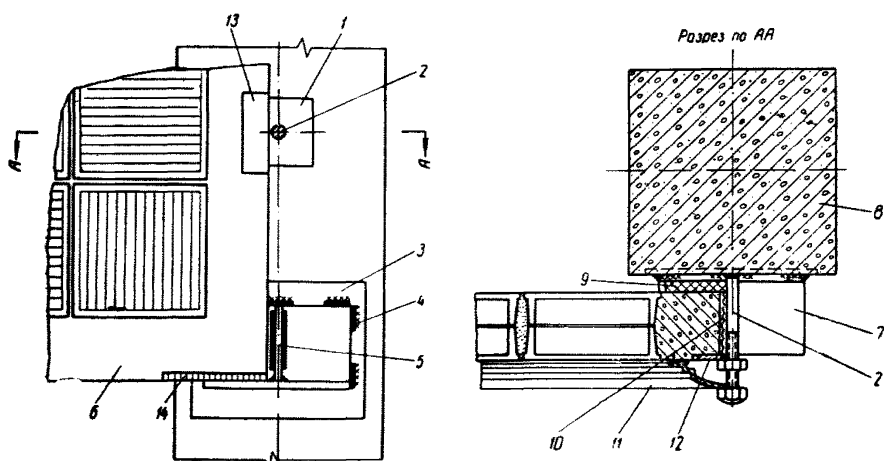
Вариант крепления вертикальной стекложелезобетонной панели к стойке каркаса
